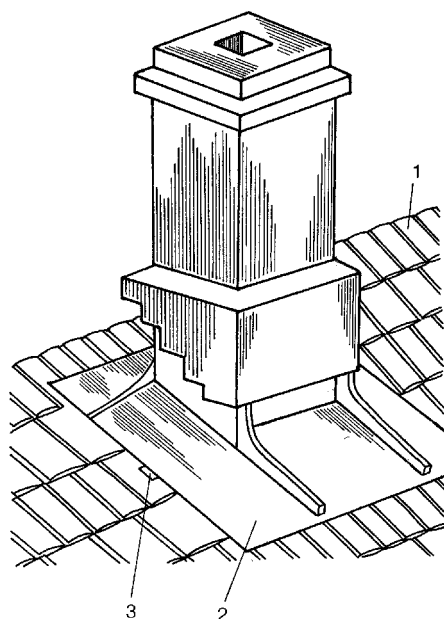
Кровля из гонта. Устройство воротника дымовой трубы
